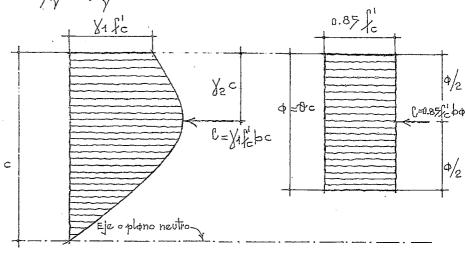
Distribución real de esfuerzos en la zona de compresión.
